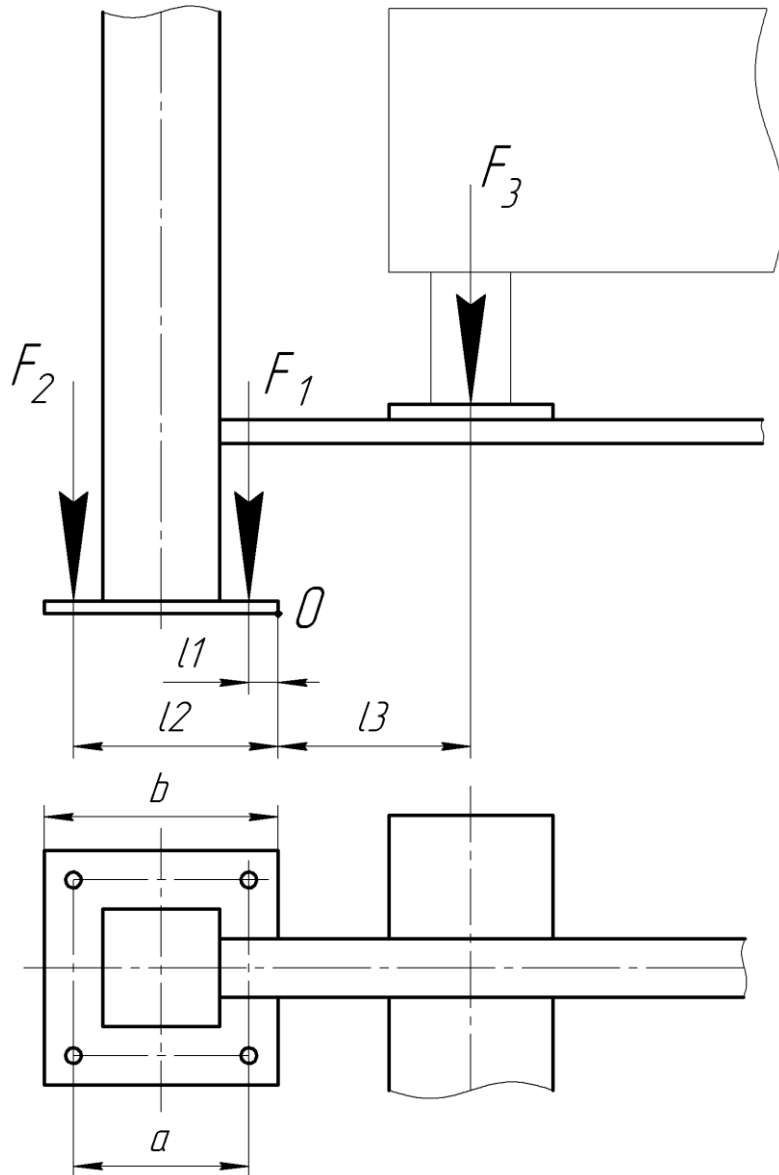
Расчетная схема для расчета фундаментных болтов для платформенного подъемника
